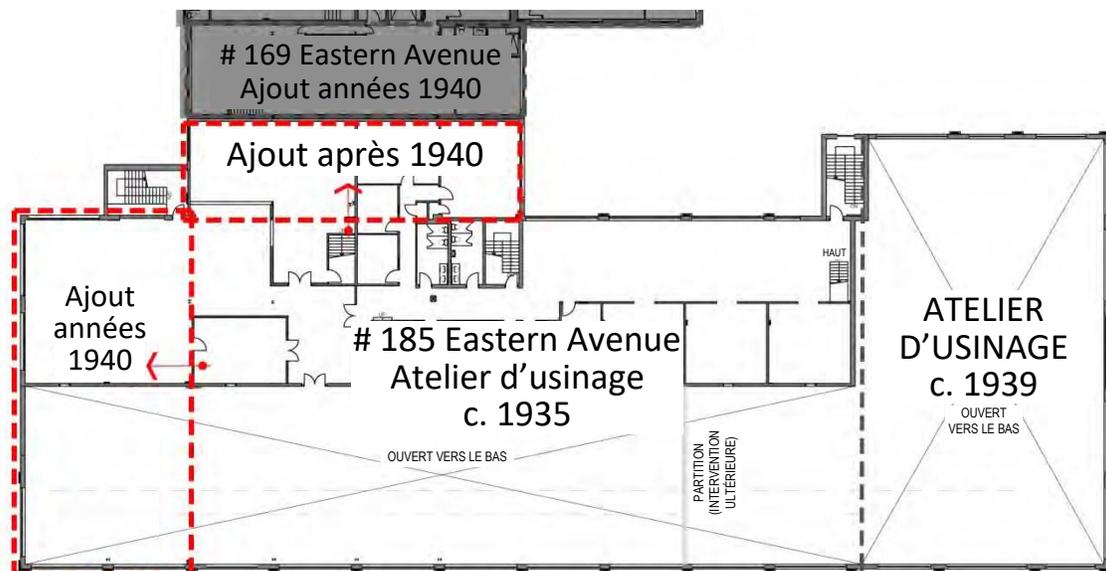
185 avenue Eastern – Atelier d'usage – Plan du deuxième étage.
